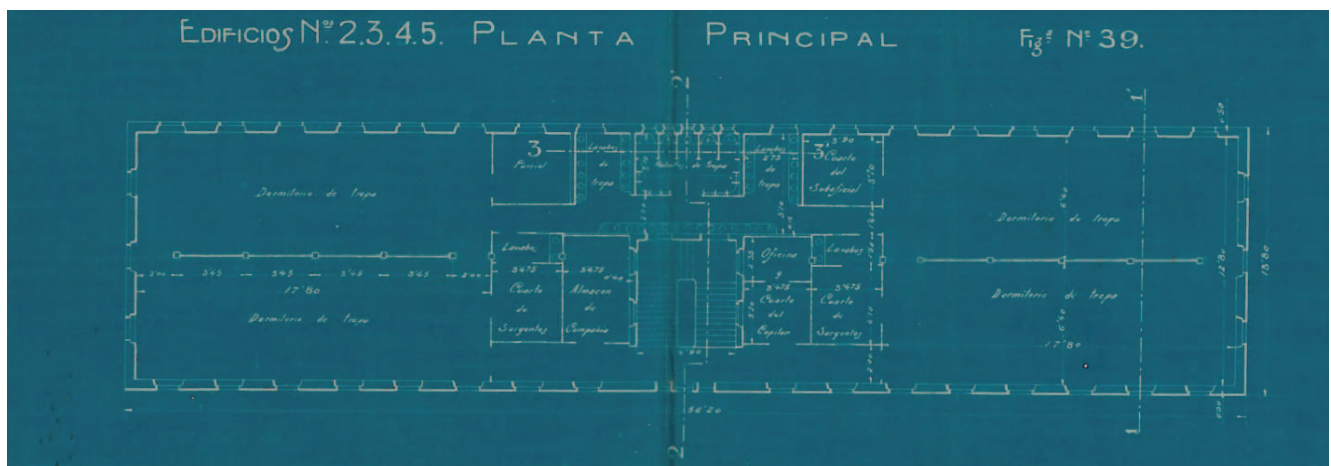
Planta de distribución original de la planta principal. Pabellón nº 4
